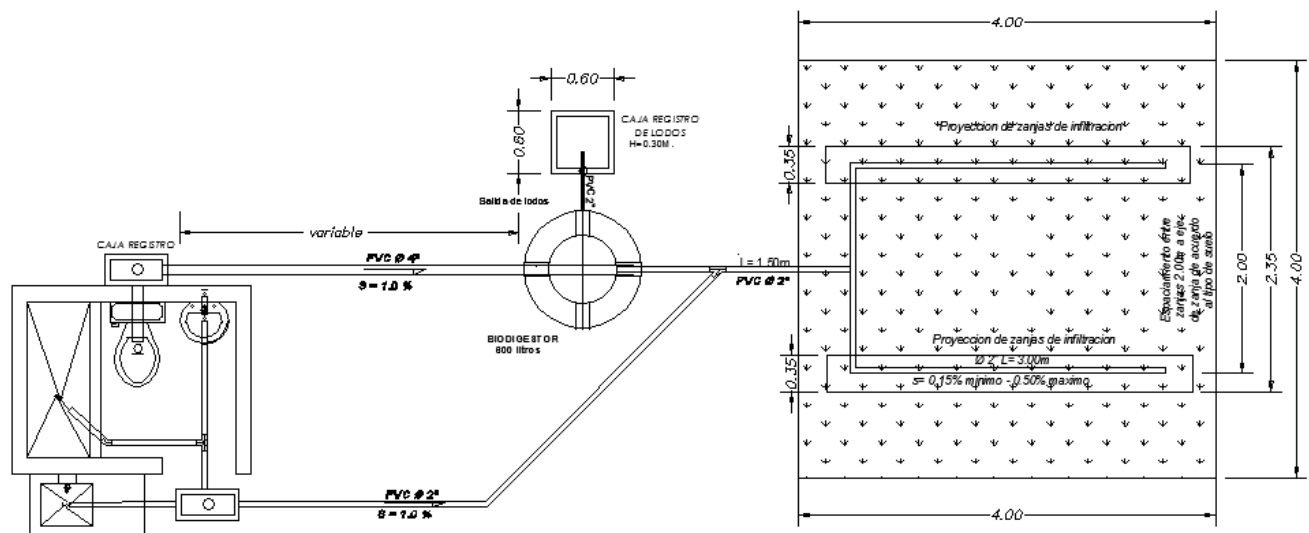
Vista en Planta del Sistema Completo de UBS y Biodigestor.
